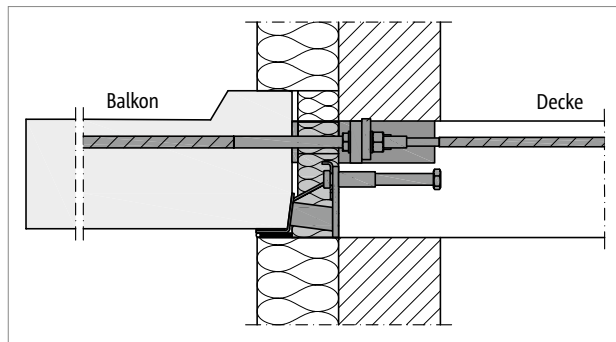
Schöck Isokorb® IQ Typ K-A: Anschluss Fertigteilbalkon mit deckenseitiger Verschraubung; die Deckenhöhe entspricht der Höhe des Schöck Isokorb®
